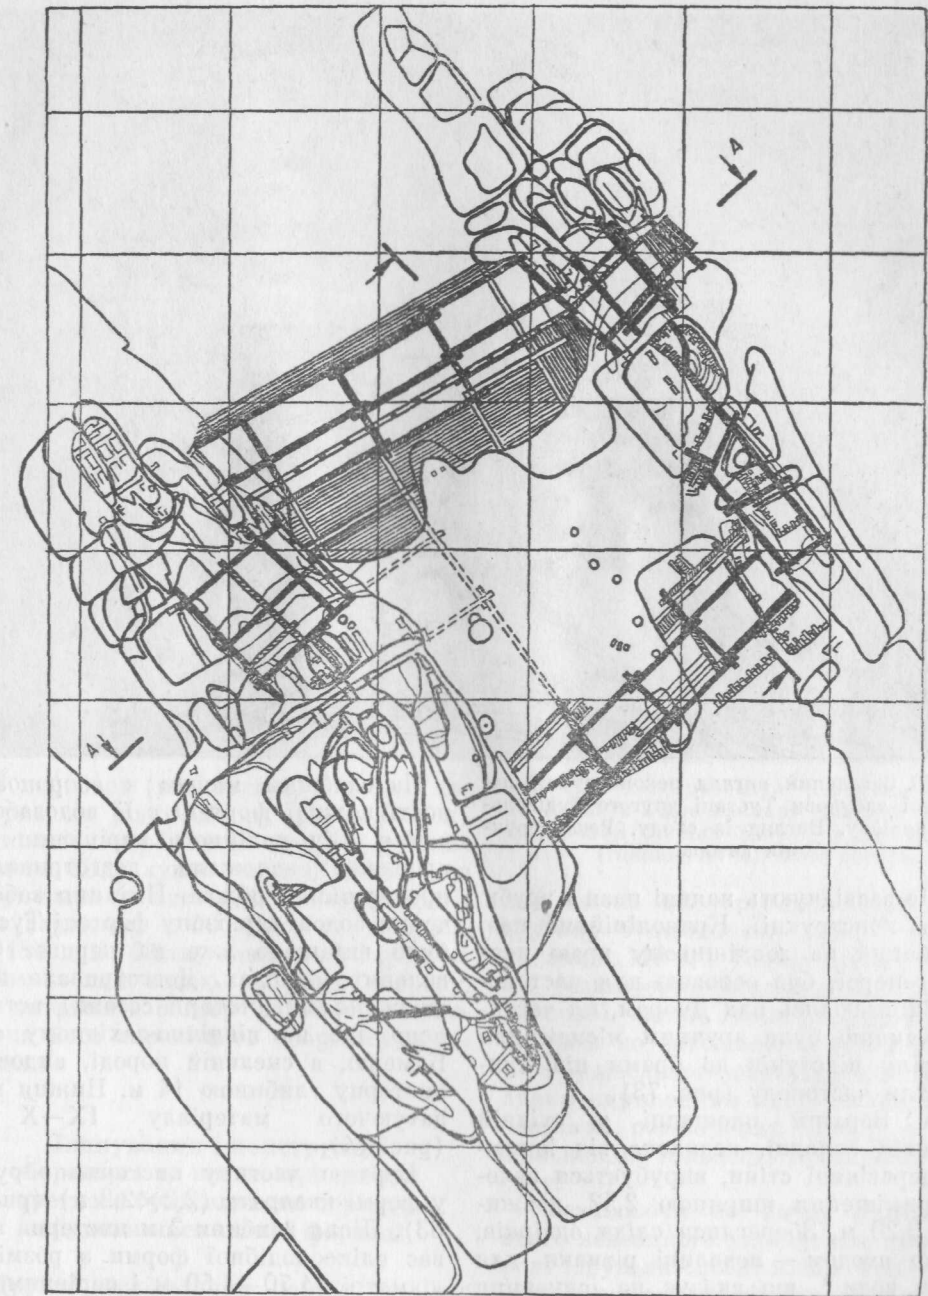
План дерев'яної забудови другого будівельного періоду.
